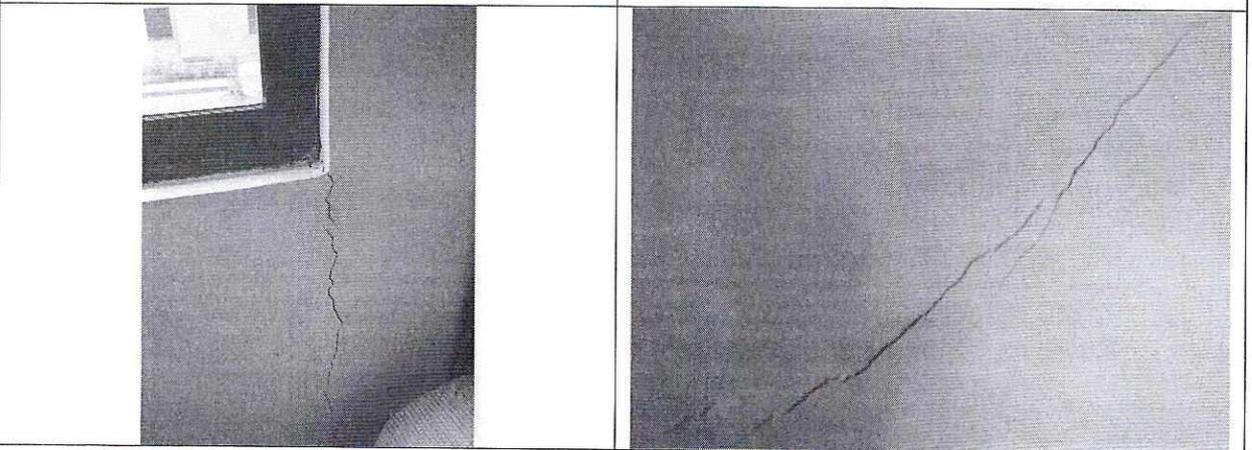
y 18. Vista interior apartamento 202. Agrietamiento muros
